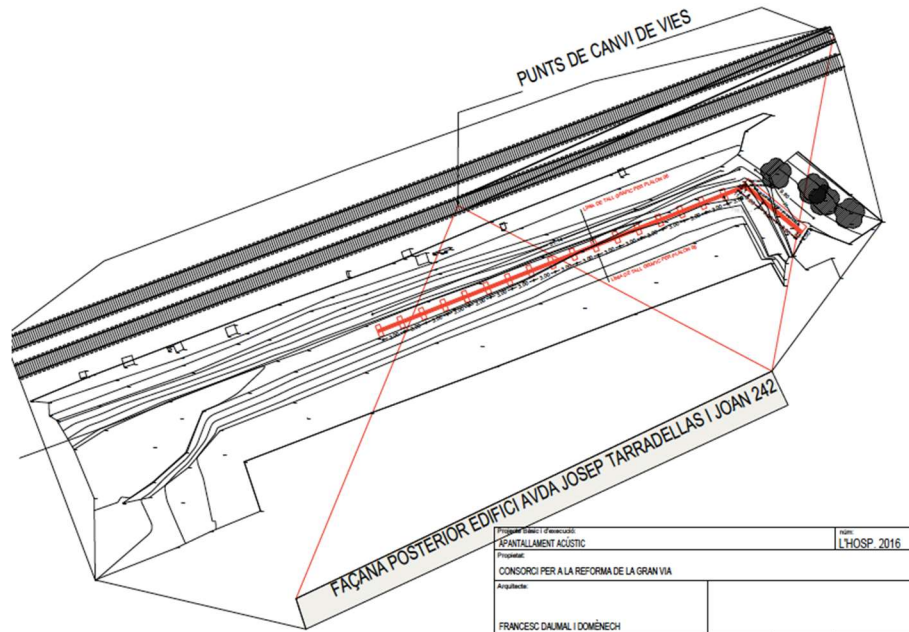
Planta de la actuación proyectada. Fuente: Pla, R.
